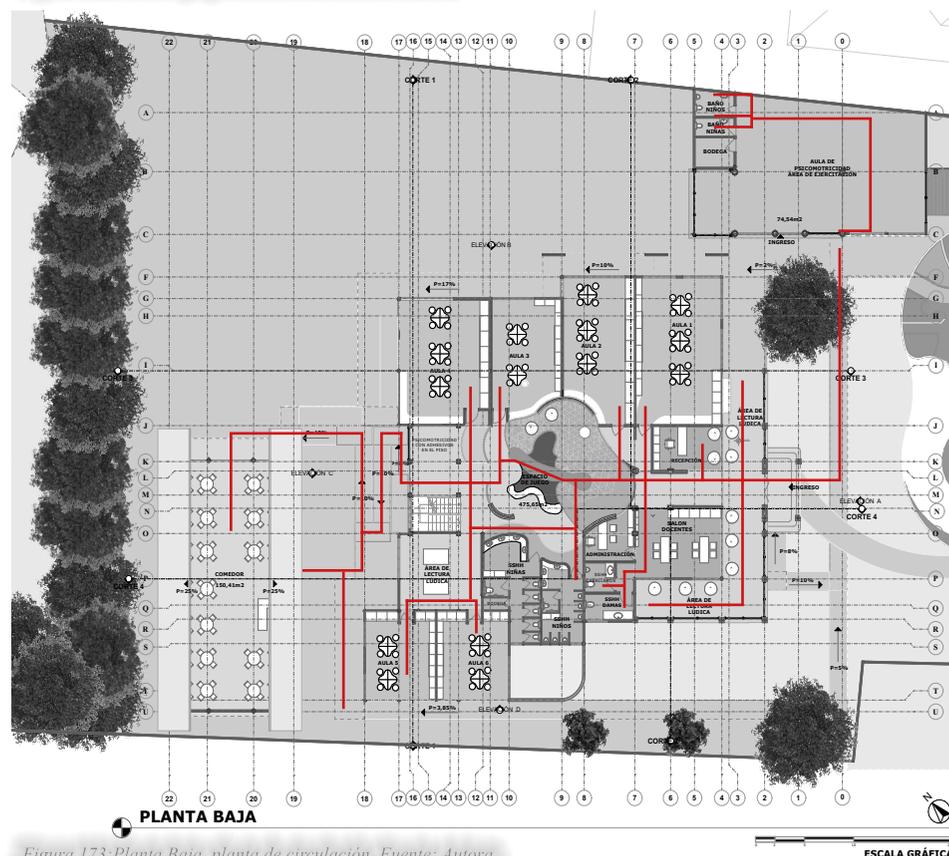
Planta Baja, planta de circulación. Fuente: Autora.
